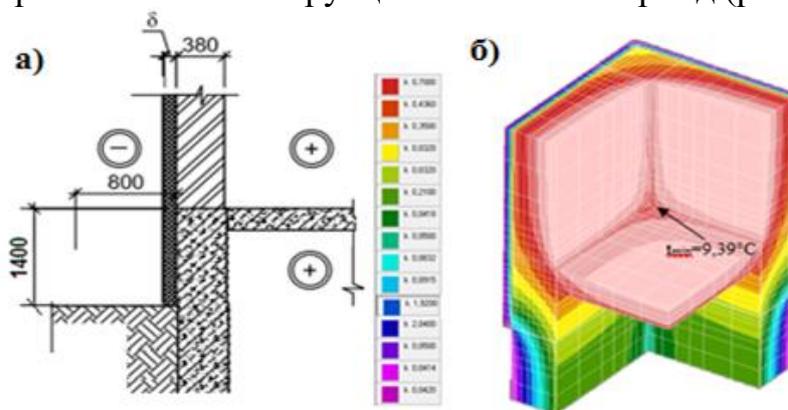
Узел примыкания наружной стены к грунту (разработанное решение): а – конструкция узла; б – температурное поле узла
